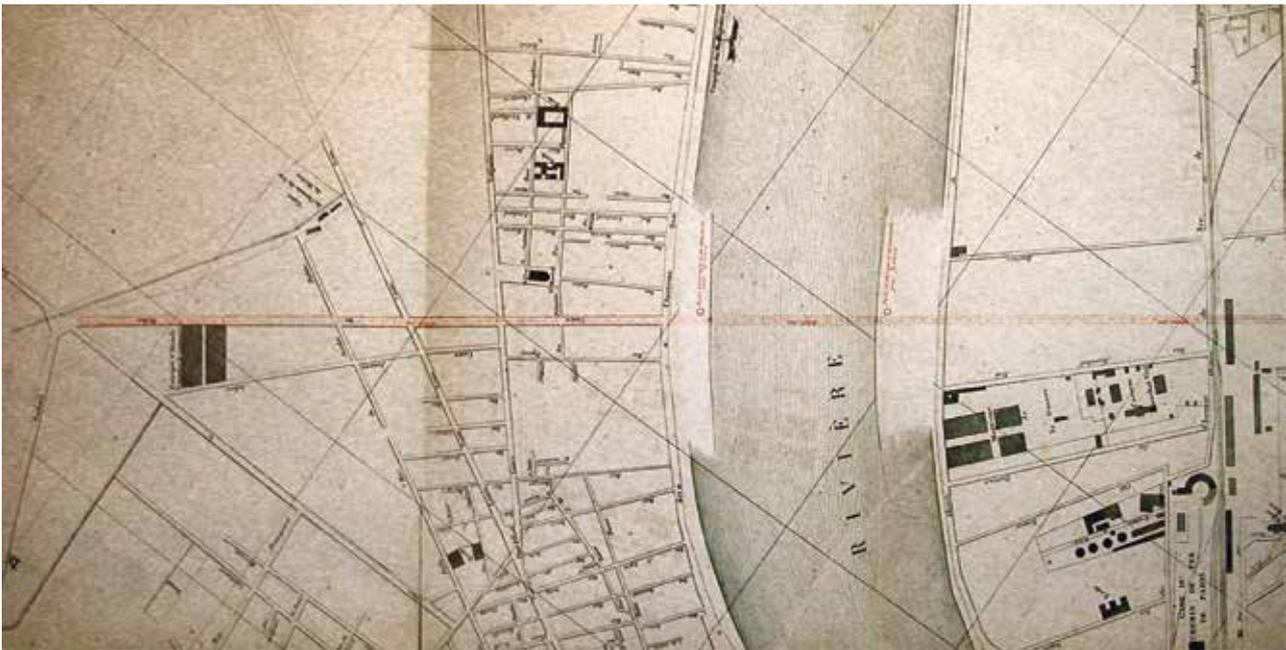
Plan d'un tunnel sous la Garonne, avant-projet, décembre 1895 (A.M.Bx., 131 O 1).
